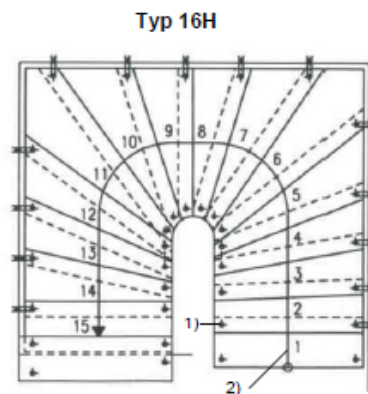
Darstellung der Grundrisse der Regeltypen bei Zweibolzentreppen (WF2) (Auszug aus Zulassung)
